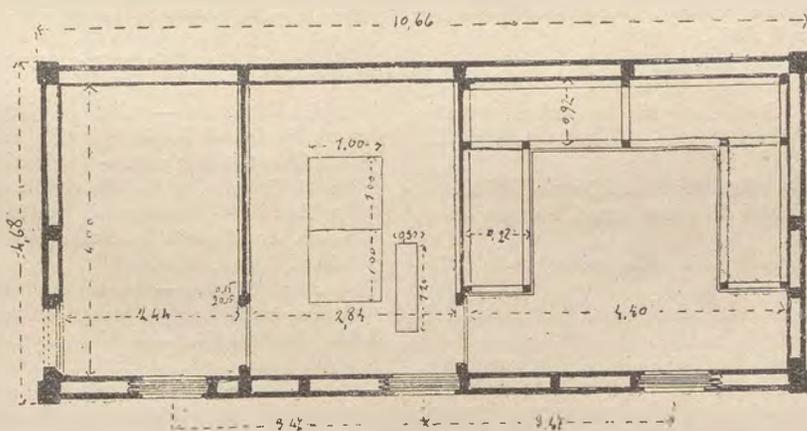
Pianta del Rifugio « Re Umberto » sul Terminillo.
